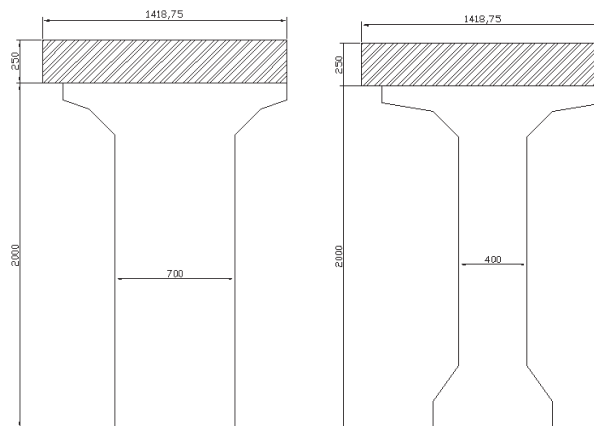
Section poutre avec hourdi de rive (zone d'about et zone médiane)
